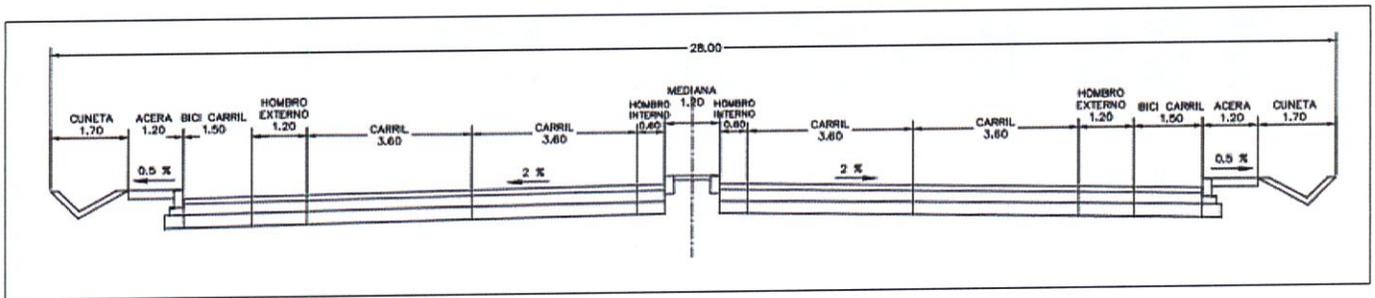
Sección Transversal Típica del proyecto en el Paquete 1.
